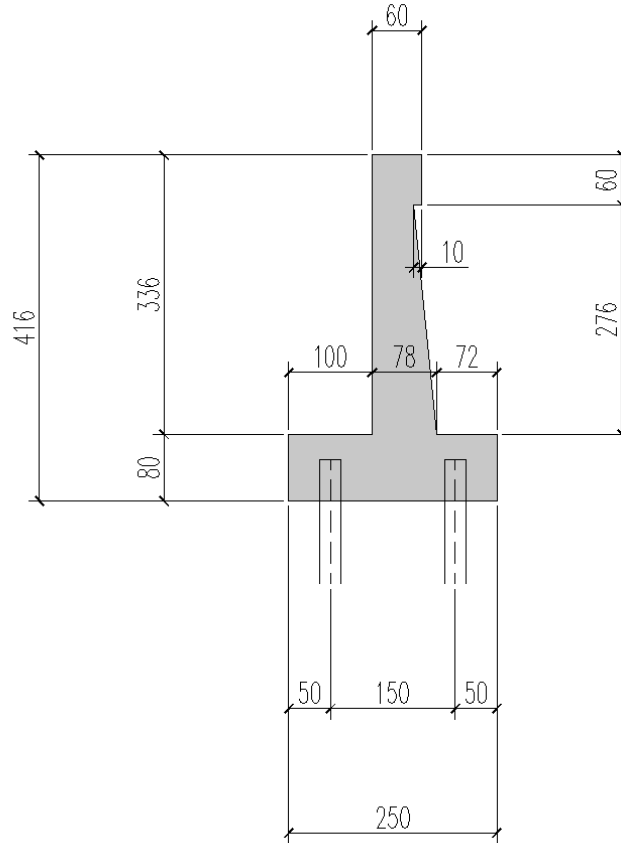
Carpenteria Sezione ad altezza maggiore del Muro M04
